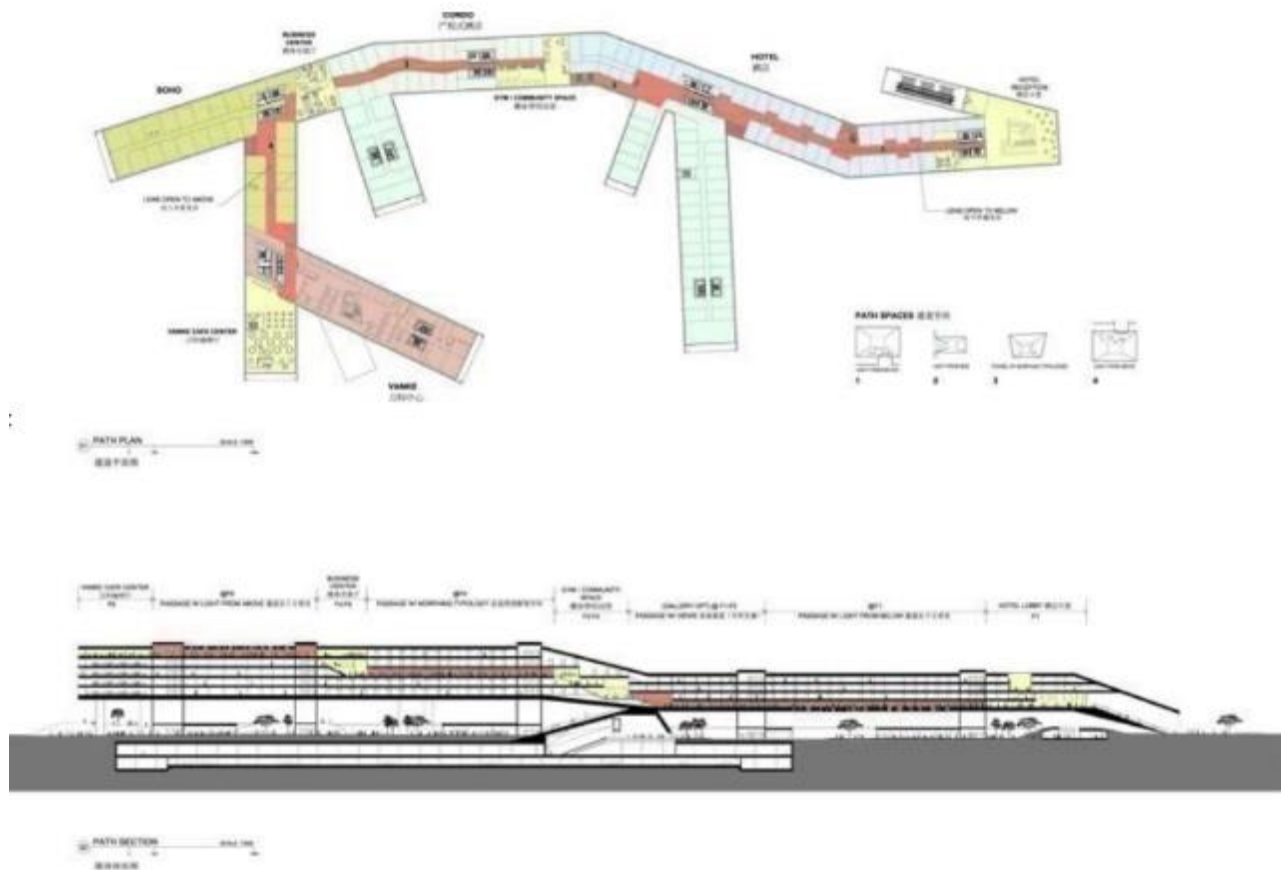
Planta General Programática-Sección. Fuente: Steven Holl Architects
